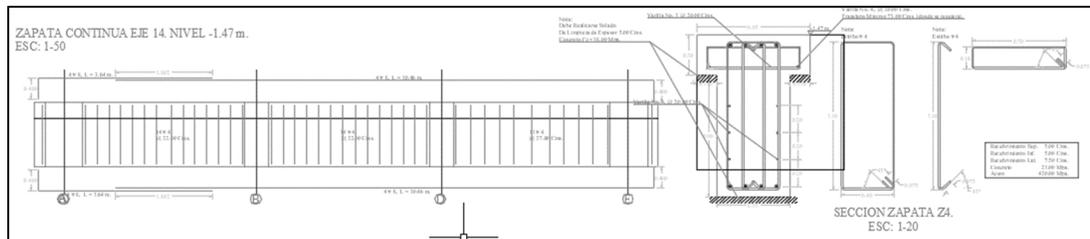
, despiece de acero de refuerzo, zapata corrida eje 14, fuente constructora Open House
